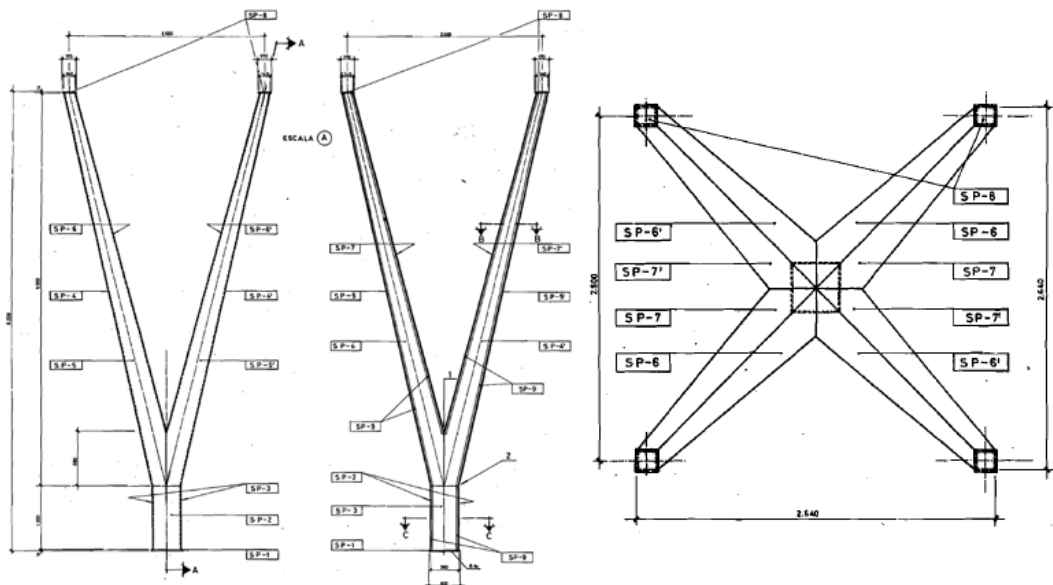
Vista alzado y su corte (izq.) y vista en planta
